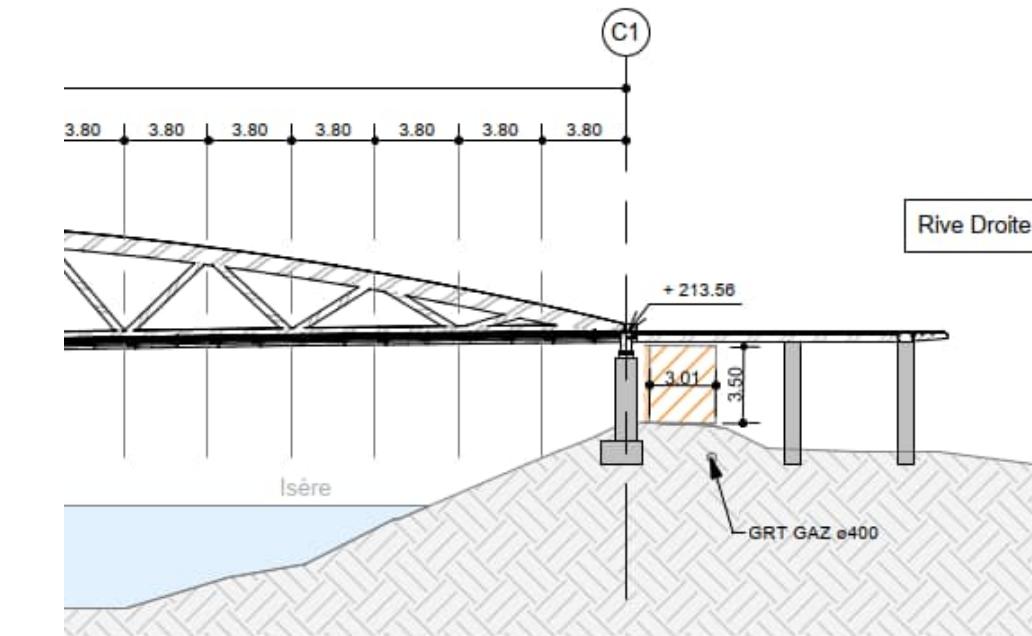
Hauteur libre pour la passerelle au niveau de la piste cyclable existante et préservation de la transparence le long de la rive droite
